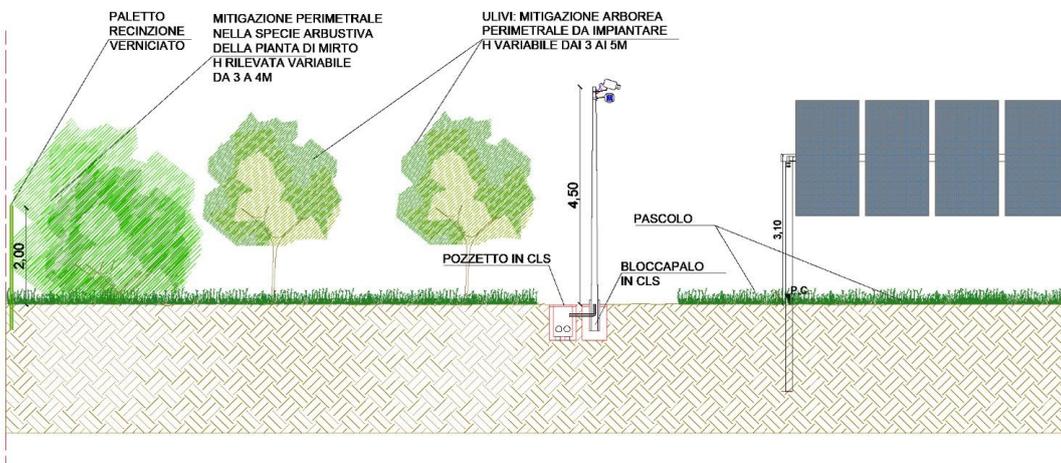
Dettaglio recinzione e mitigazione perimetrale
